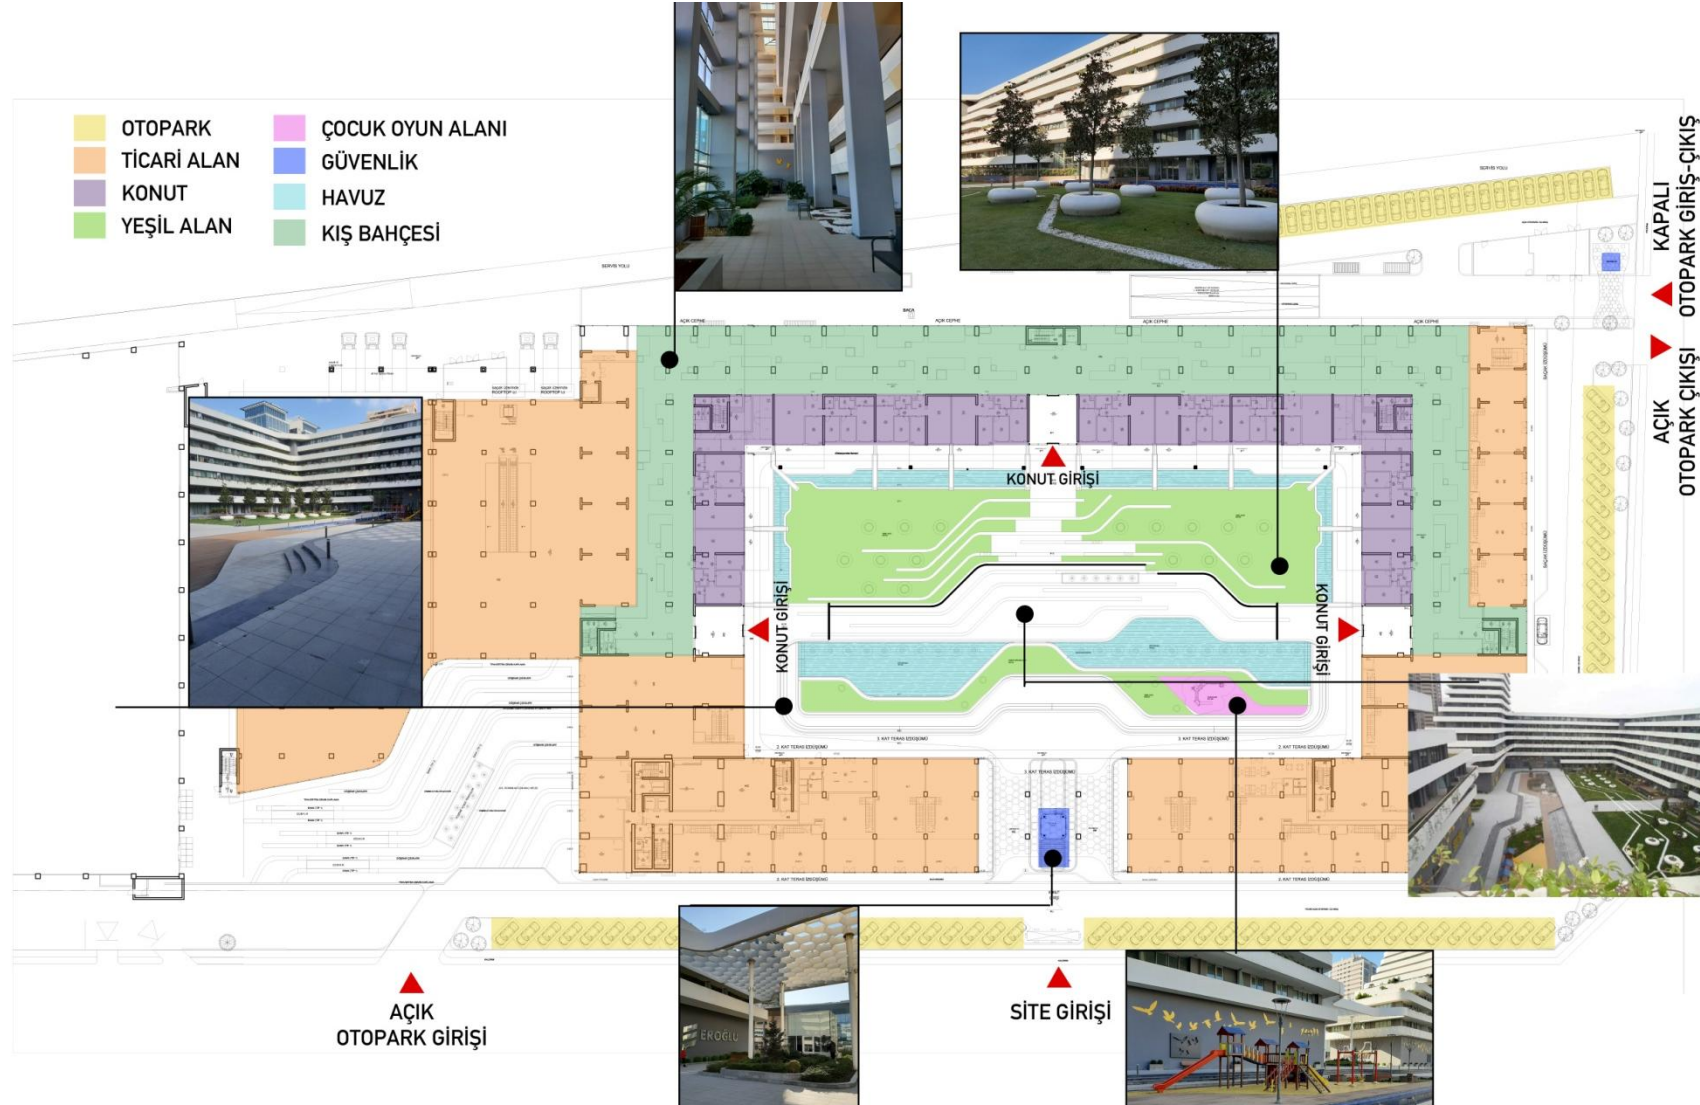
Sur Yapı Marka projesi sosyal alan kat planı
